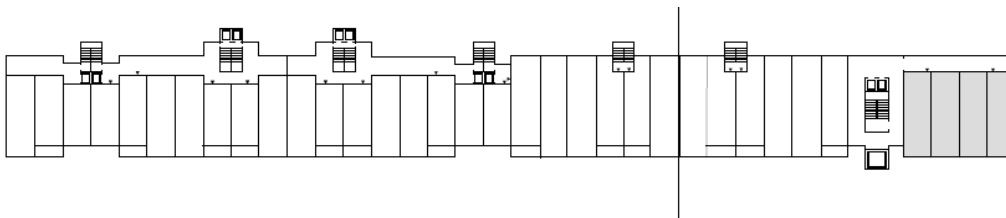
Planimetria della "Diga Rossa" e individuazione del Civico 80 e degli alloggi pilota
